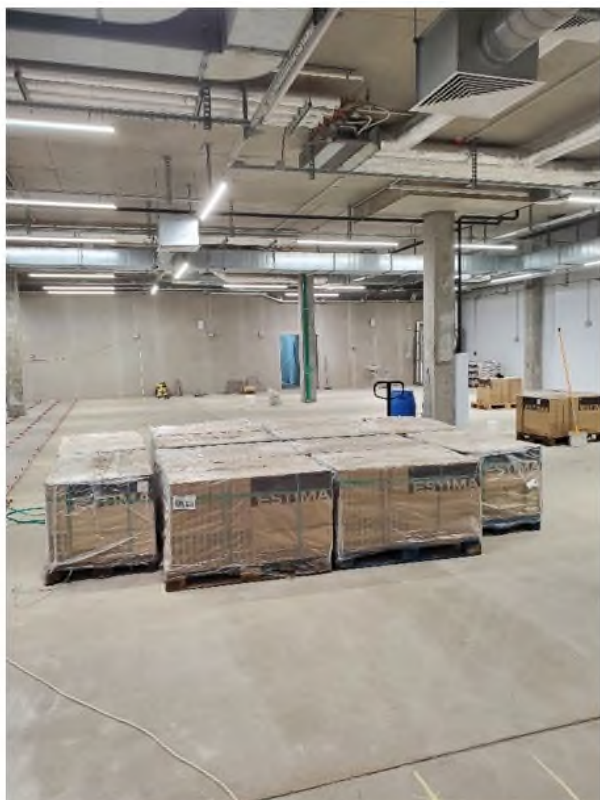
Вид нагруженной железобетонной плиты перекрытия подземного паркинга
